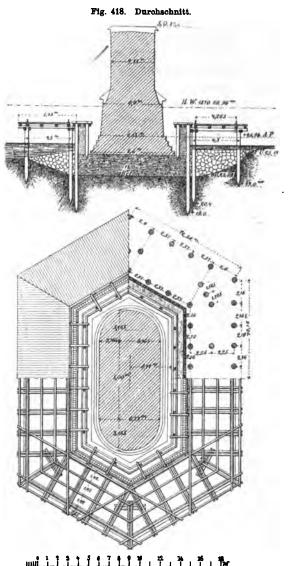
Grundriss des Strompfeilers II der Ruhrbrücke bei Düssern.
